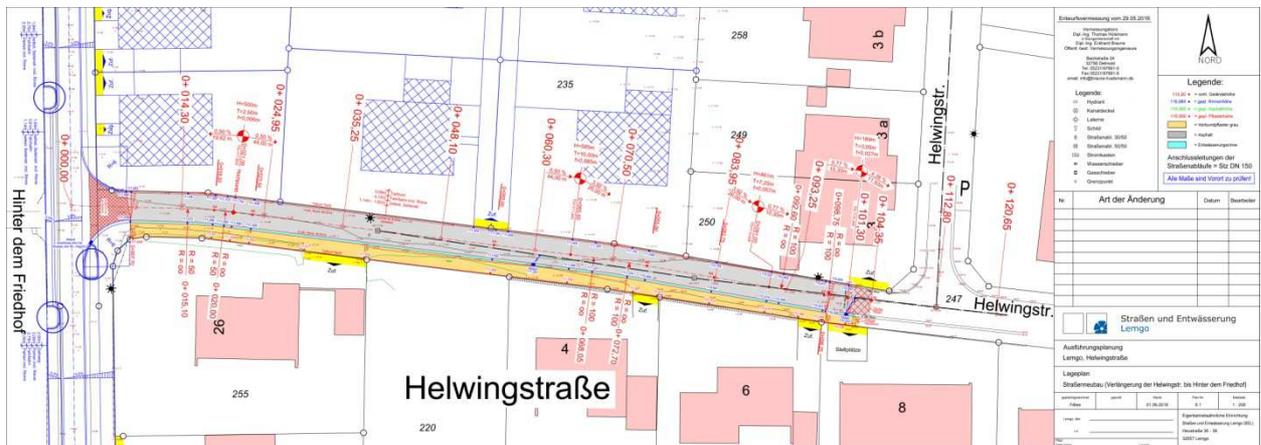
Vorabzug Straßenplanung Helwingstraße Lageplan (ohne Maßstab)
